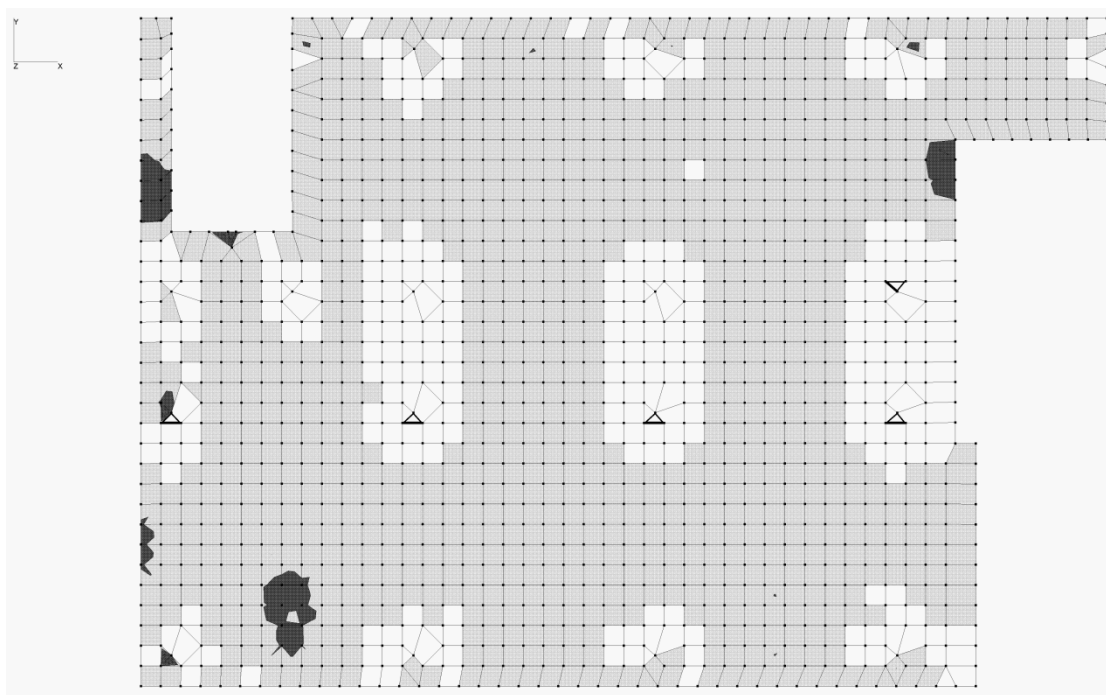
Армування нижньої зони вздовж осі Y
